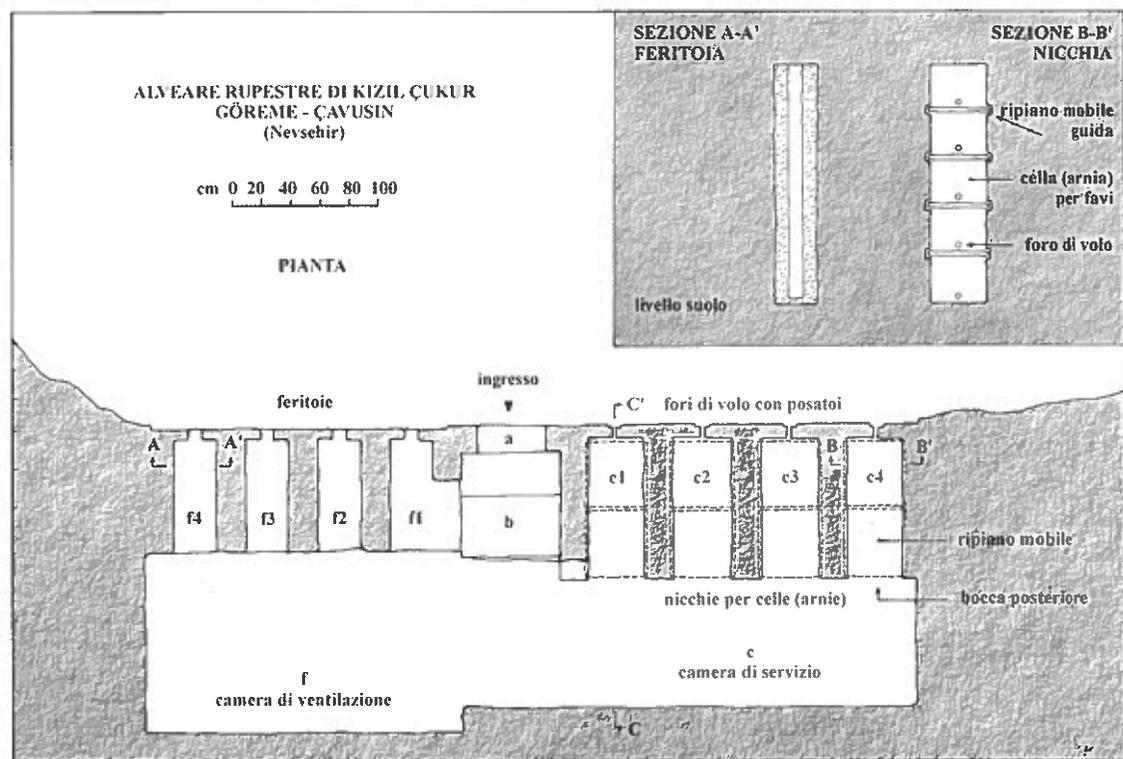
alveare di Kizil Çukur. Planimetria e sezioni delle feritoie e delle nicchie (grafica R. Bixio, A. Bixio)
